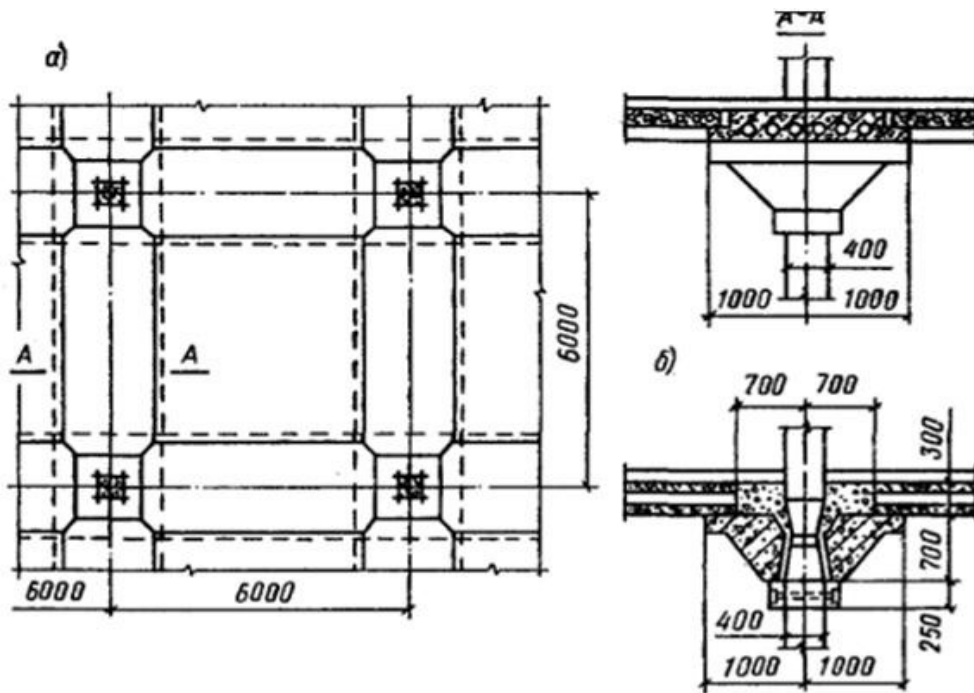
Конструкция безбалочного сборного перекрытия с пустотными панелями
